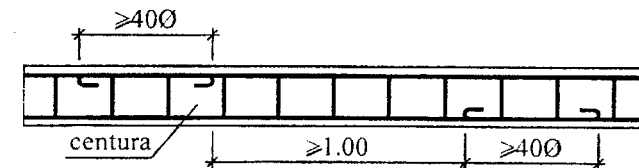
Înădirea barelor longitudinale din centuri
